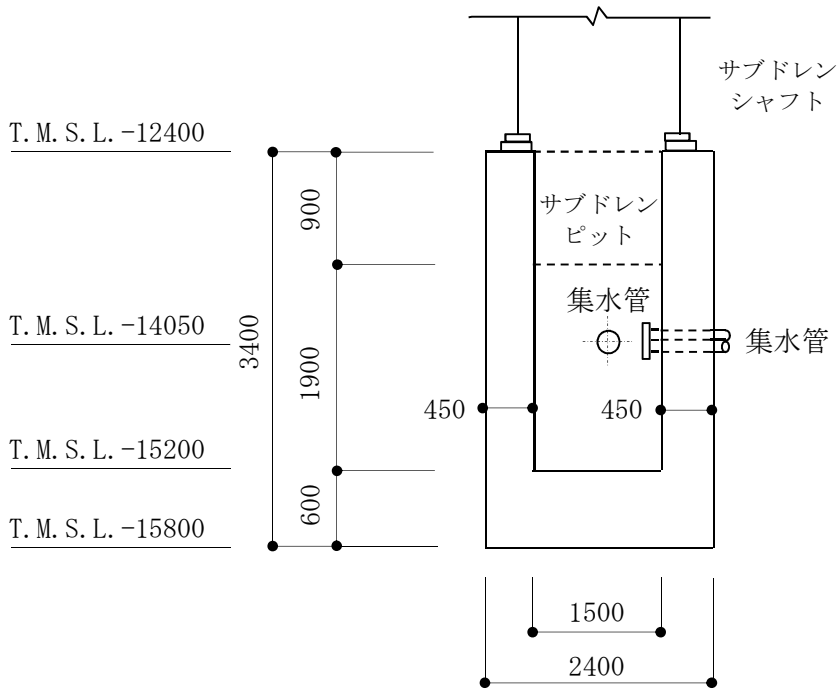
原子炉建屋サブドレンピットの概略断面図 (A-A断面) (単位 : mm)
